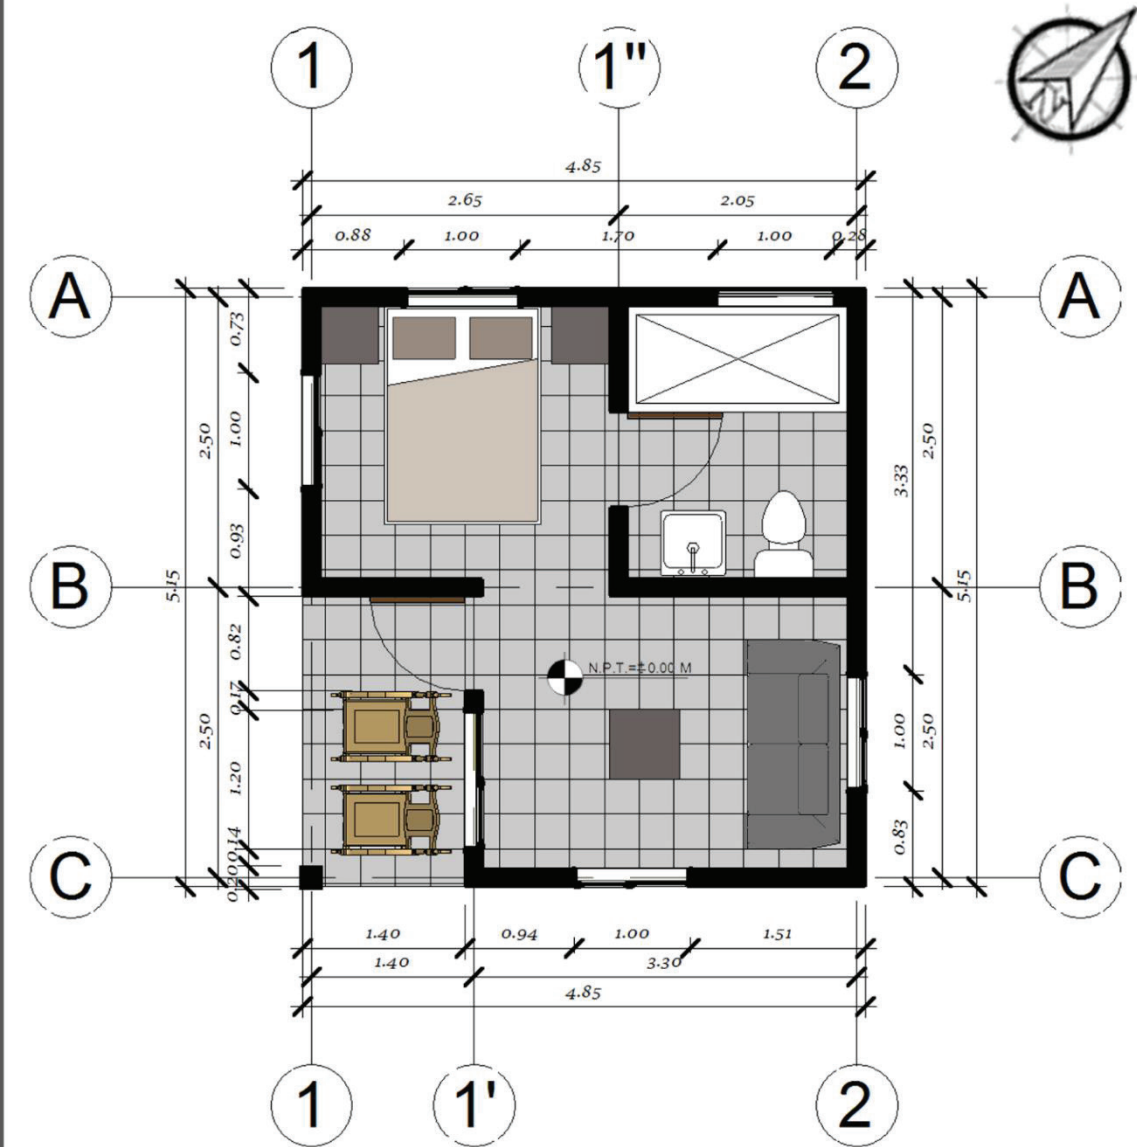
Plano arquitectónico de Cabaña Sencilla de Hotel Selva Negra. Fuente: Elaboración propia.
